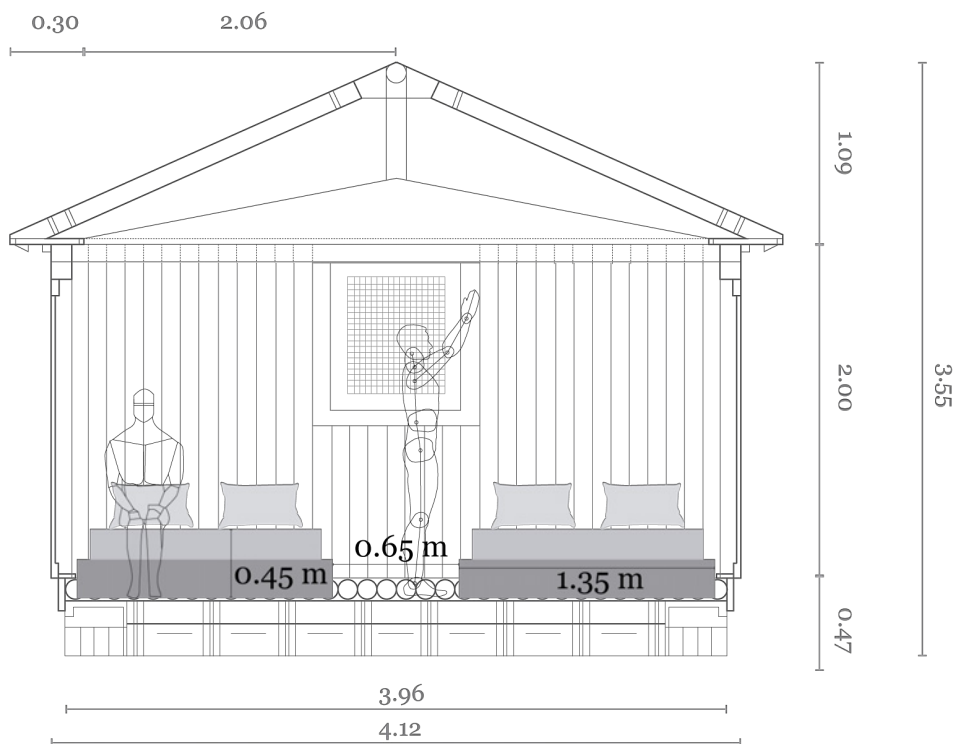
Sección A-A del Paper Log House. Elaboración: Autores. Escala 1:50
